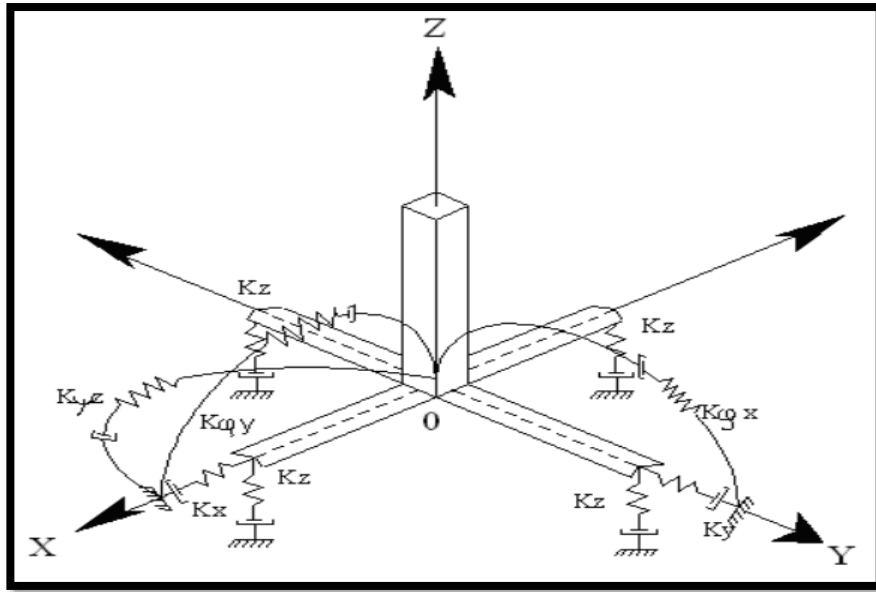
Esquema espacial de cálculo de cimentación tipo zapata aislada considerando la interacción del suelo. Fuente: Villarreal (2009).
